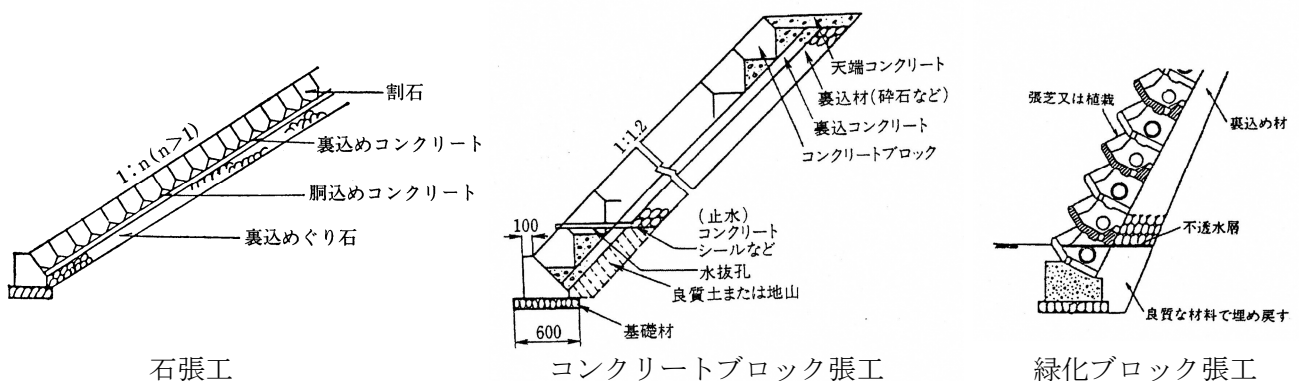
石張工、コンクリートブロック張工、緑化ブロック張工の例
